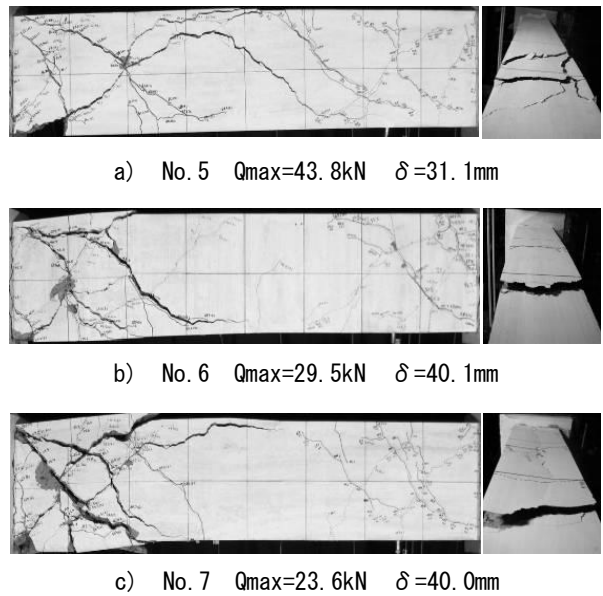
最終破壊状況及び上面ひび割れ状況
